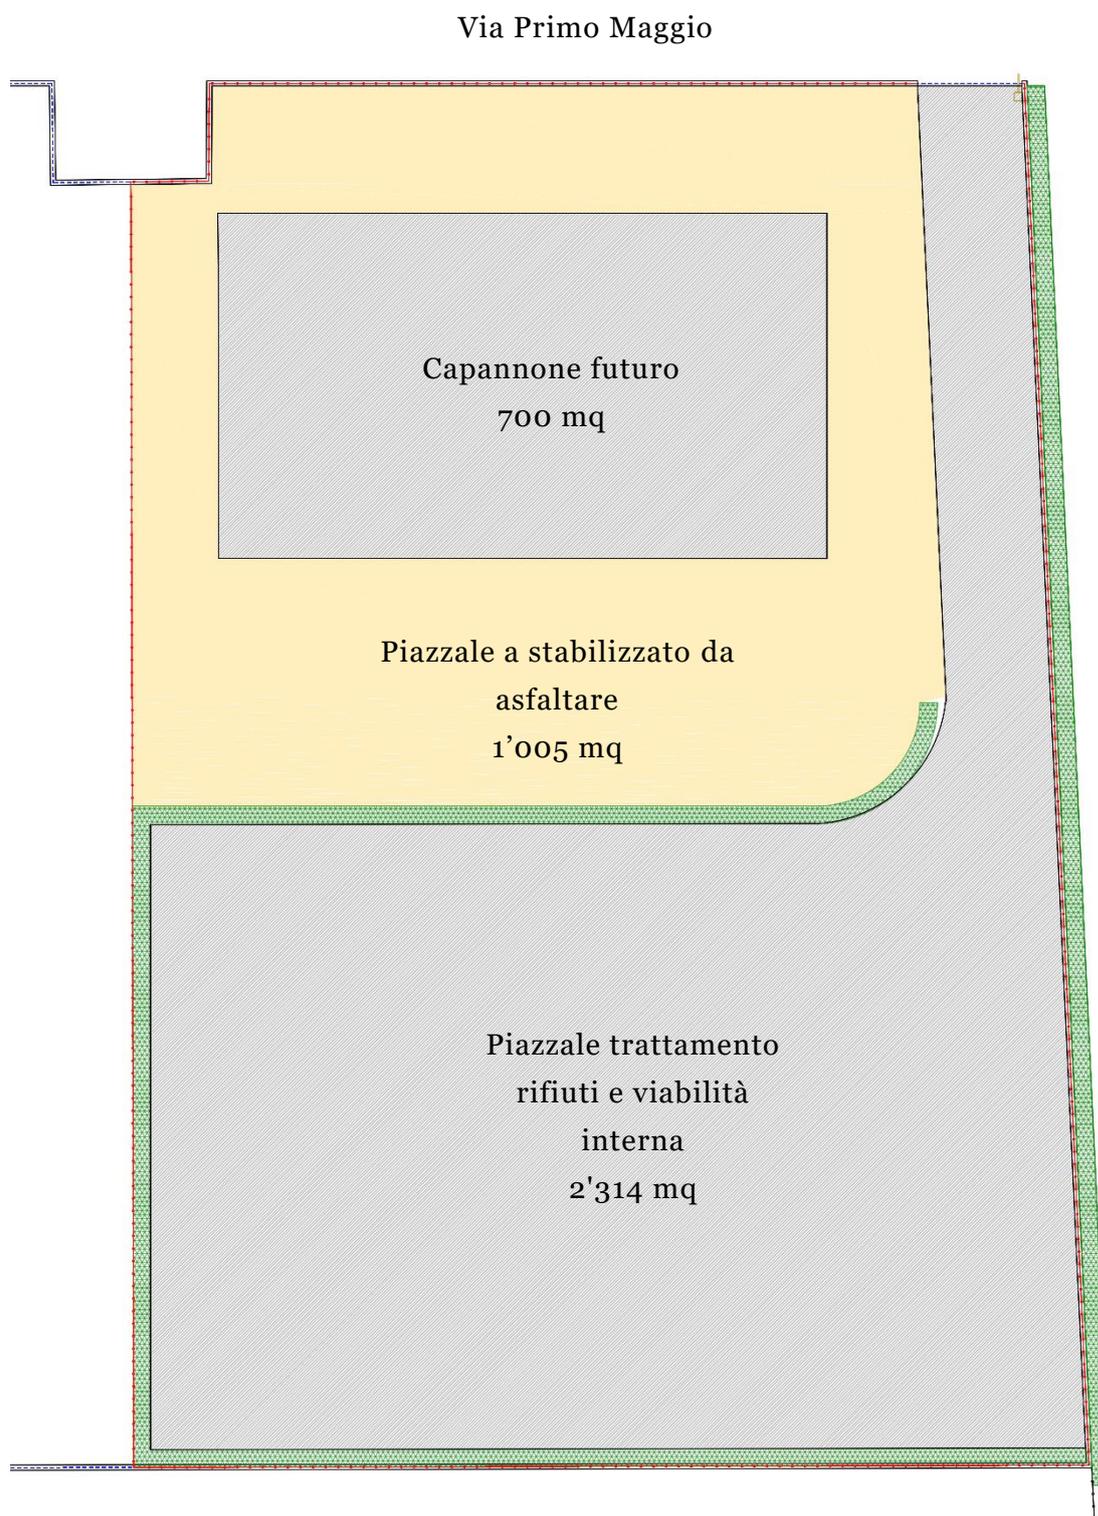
Planimetria con individuazione aree a verde (verde), permeabili (giallo) e impermeabili (grigio)
